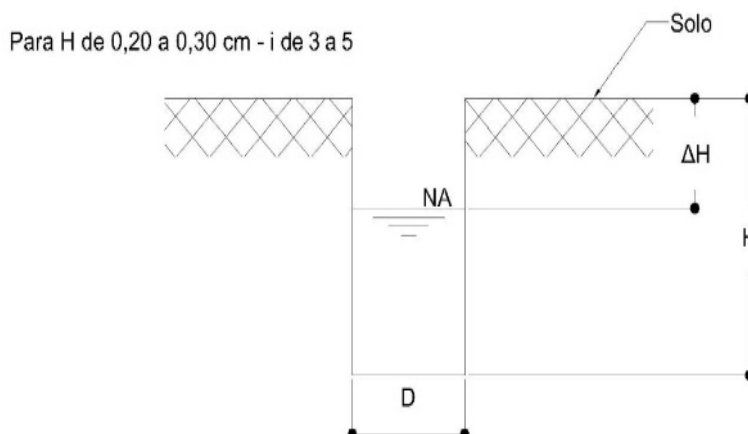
Ensaio de Rebaixamento ABGE 1996.
